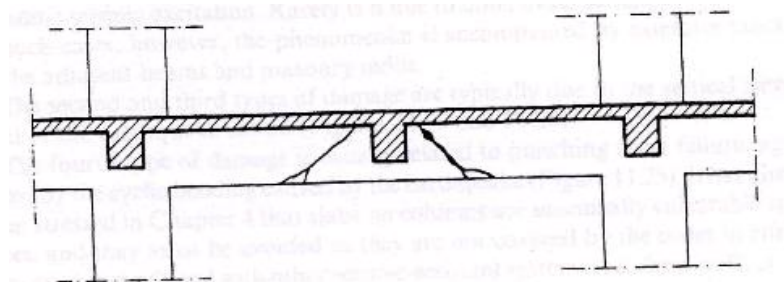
Échec de cisaillement ou de flexion dans les points où les poutres principales sont les supports des poutres secondaires.
